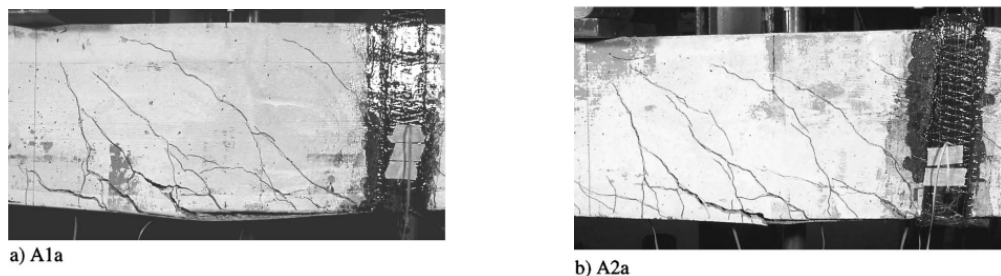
Despegue en la zona de fisuras de flexión-cortante en vigas con anclaje en ambos extremos. (Fuente: Pham Huy B., et al. (2006))
